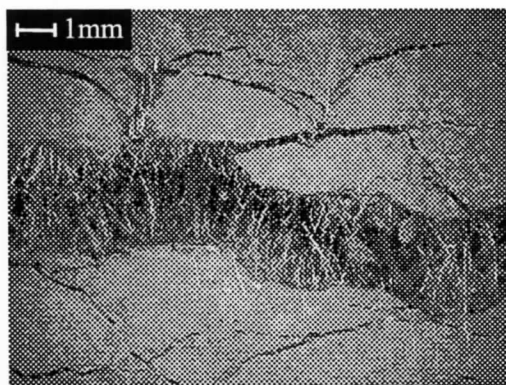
引張試験体ひび割れ内の繊維架橋状況
